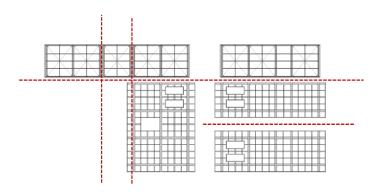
(f) Denah Pembalokan Lantai 4
